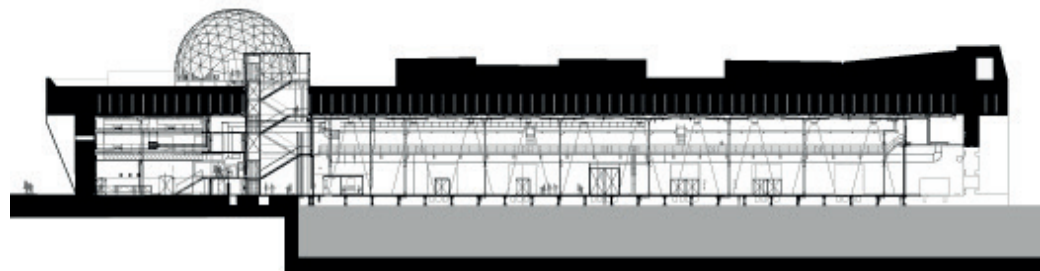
Coupe longitudinale du projet Alvéole 14.
